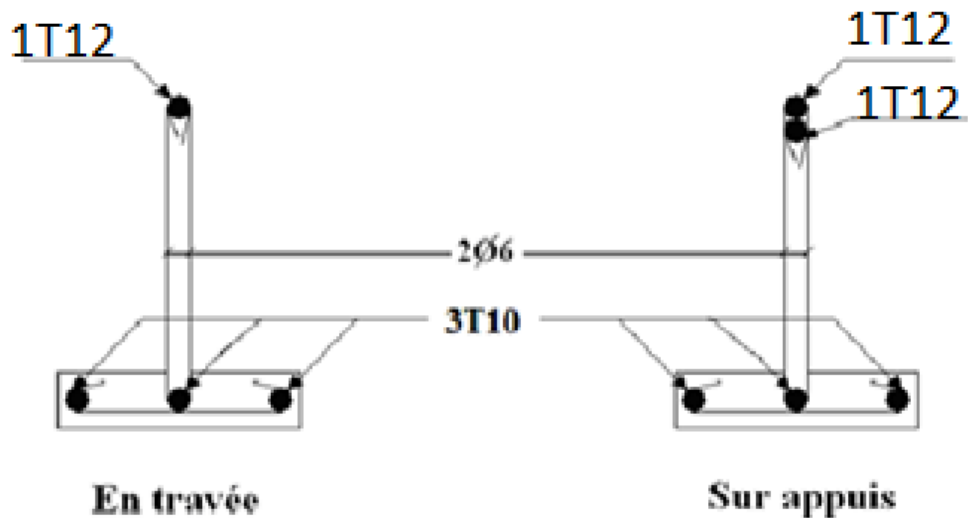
Ferrailage des poutrelles en Travée et en Appuis.
